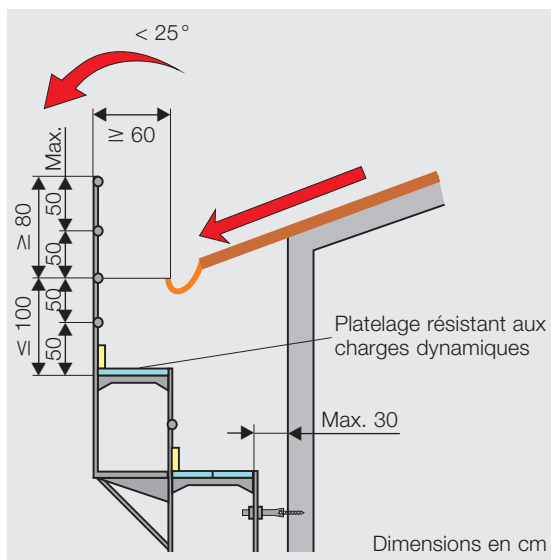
protection latérale d'un pont de ferblantier pour un toit de pente $< 25^\circ$.
